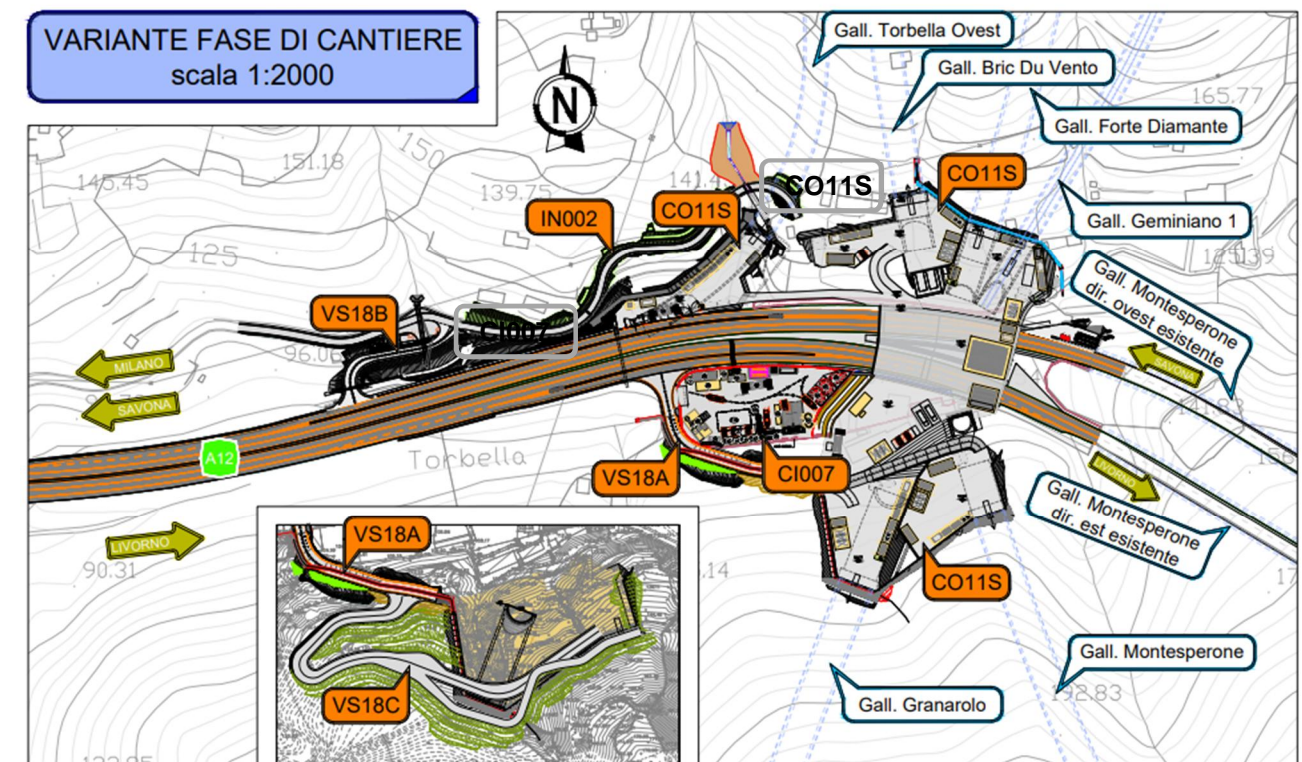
Localizzazione aree di cantiere – Interconnessione Torbella
